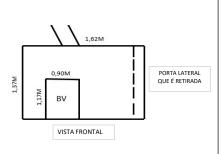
Croqui / PlantaBaixa /Desenho do local objetivando entradas
